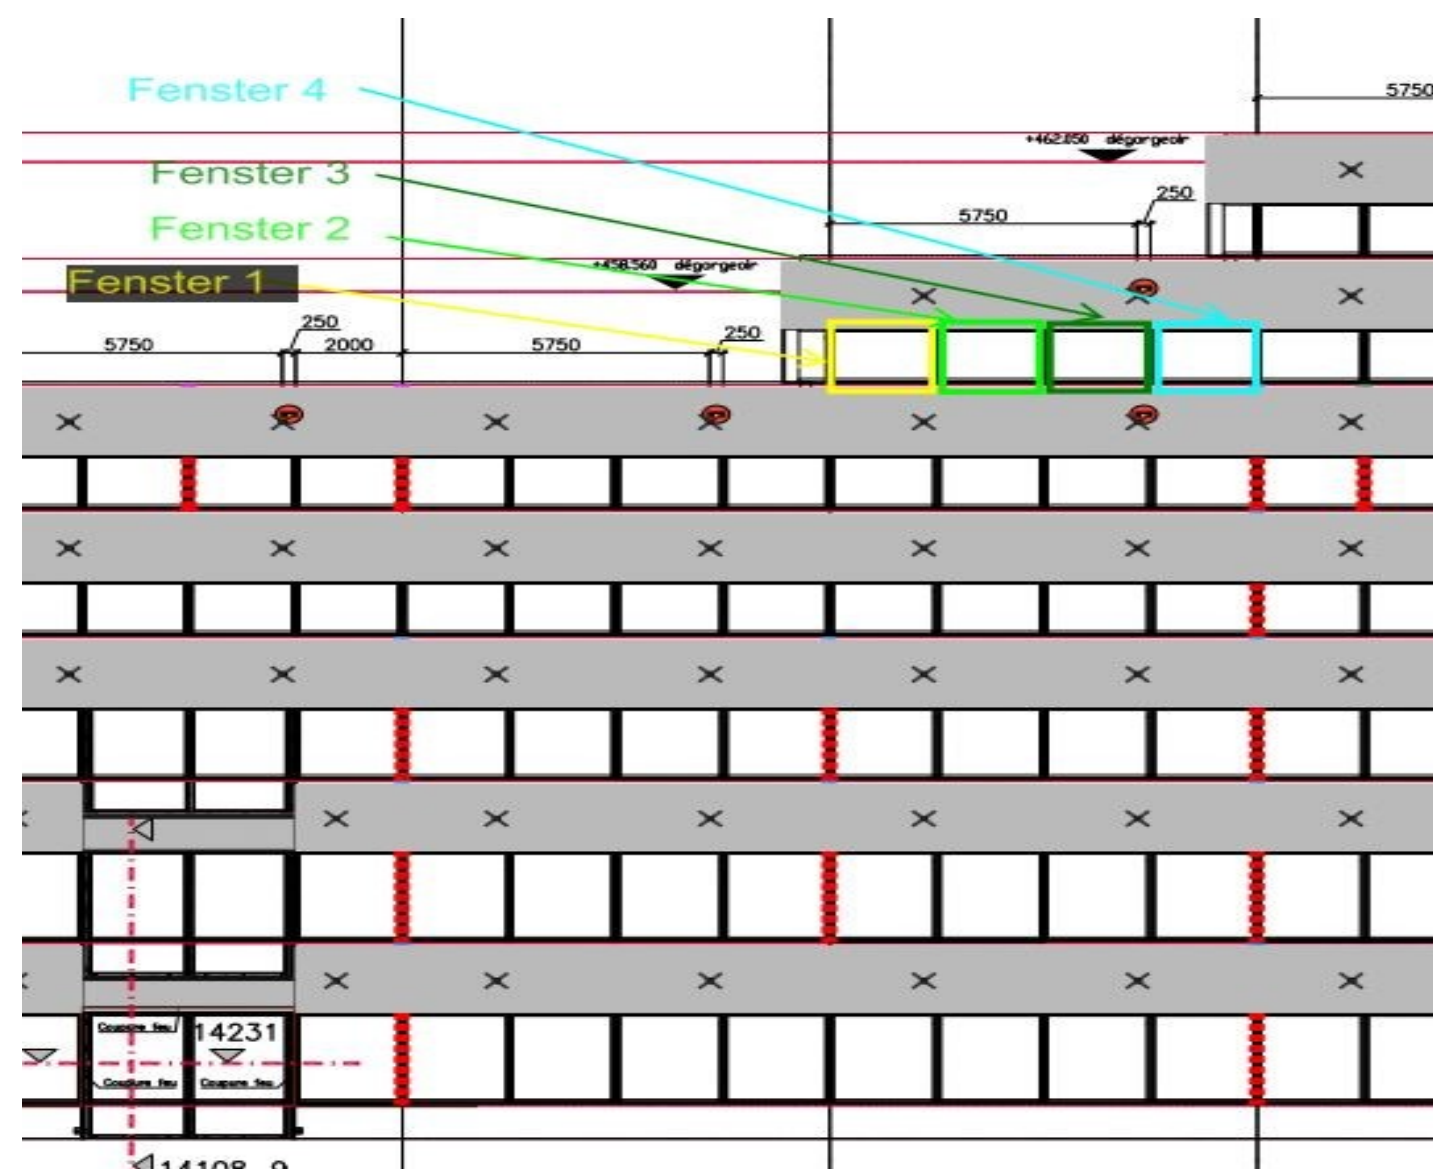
Planausschnitt Fassadenansicht Süd-Ost mit markierten Messbereichen
